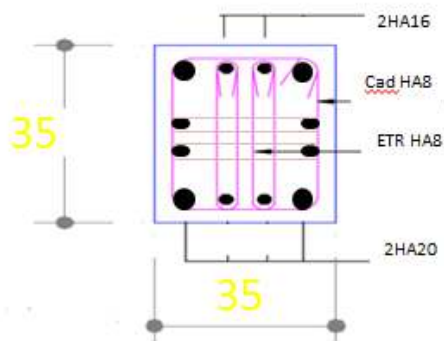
Ferrailage des poteaux de 5^{ème} et 6^{ème} étage de RDC
